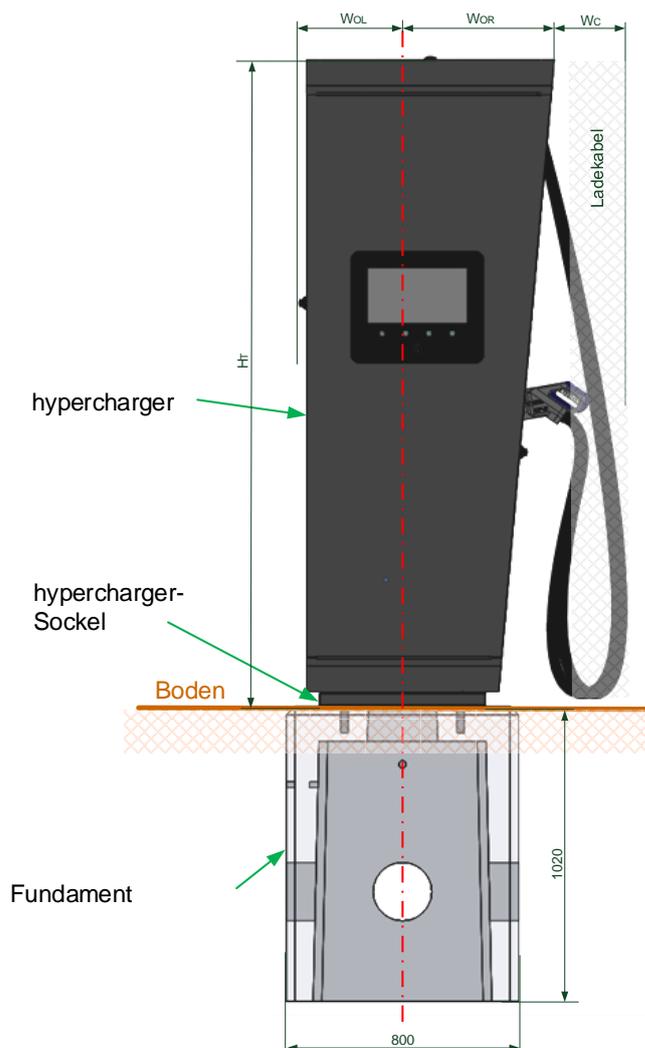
Relevante Komponenten für die mechanische Installation des hyperchargers
